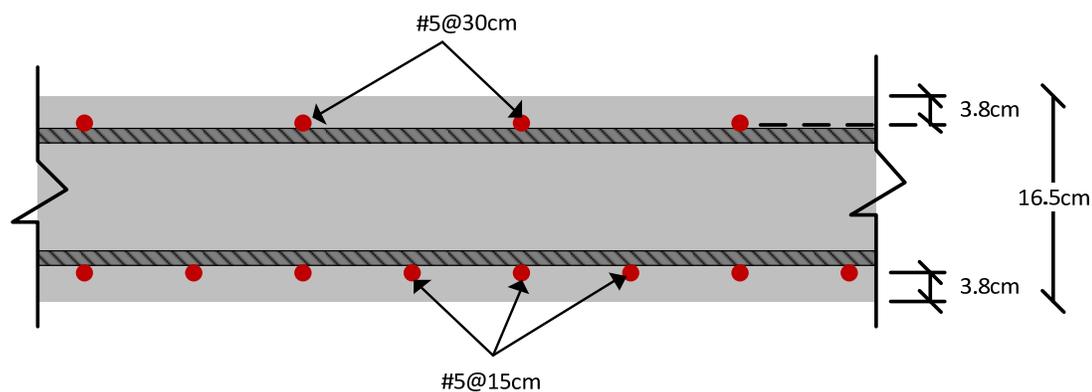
Esquema del refuerzo de la losa (Corte Longitudinal)
